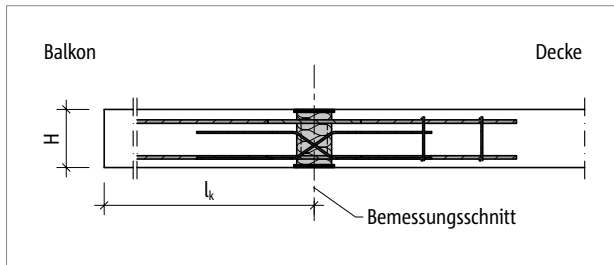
Schöck Isokorb® XT Typ DP: Statisches System
